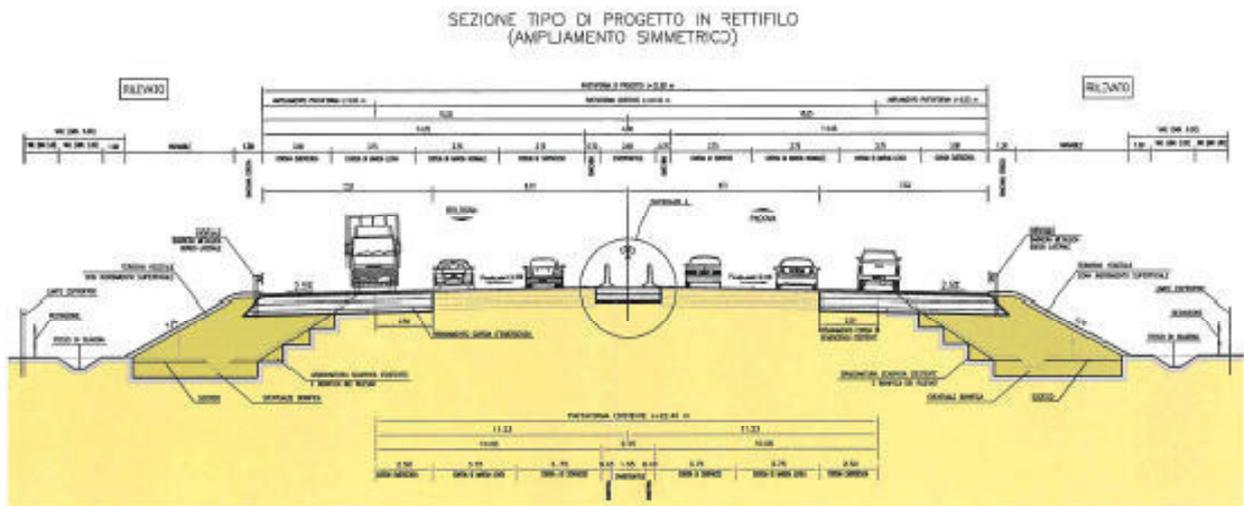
sezione tipo di progetto rettilo, ampliamento simmetrico
